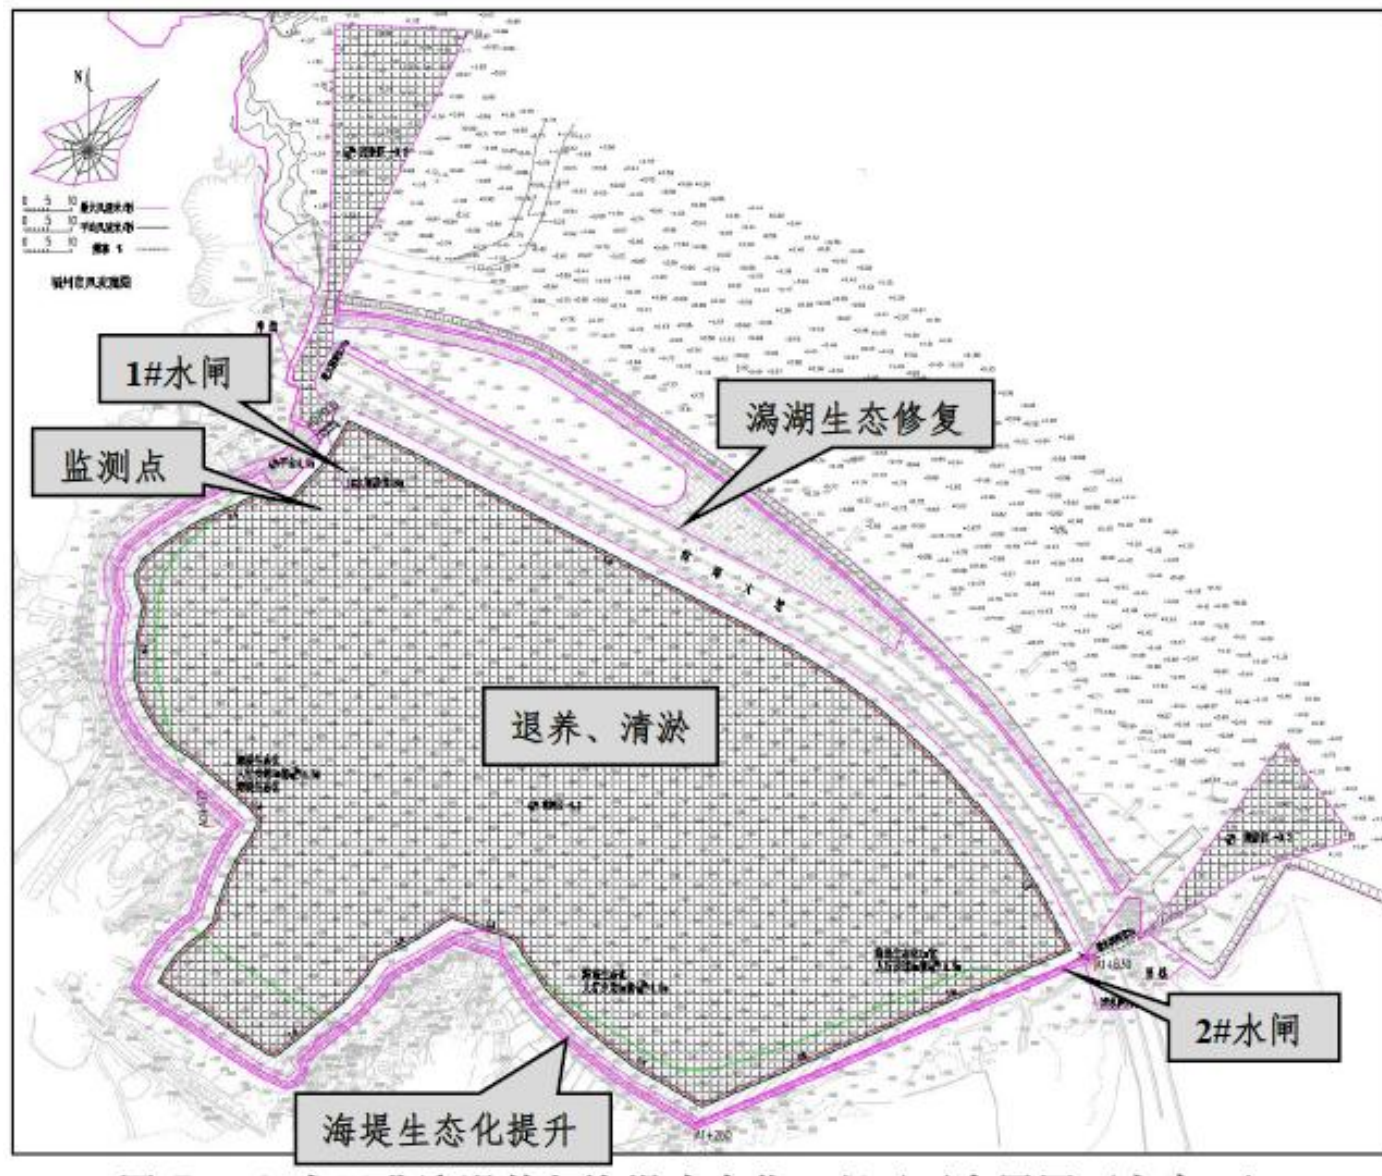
龙田北澳退养与海堤生态化工程平面布置图总平面图
